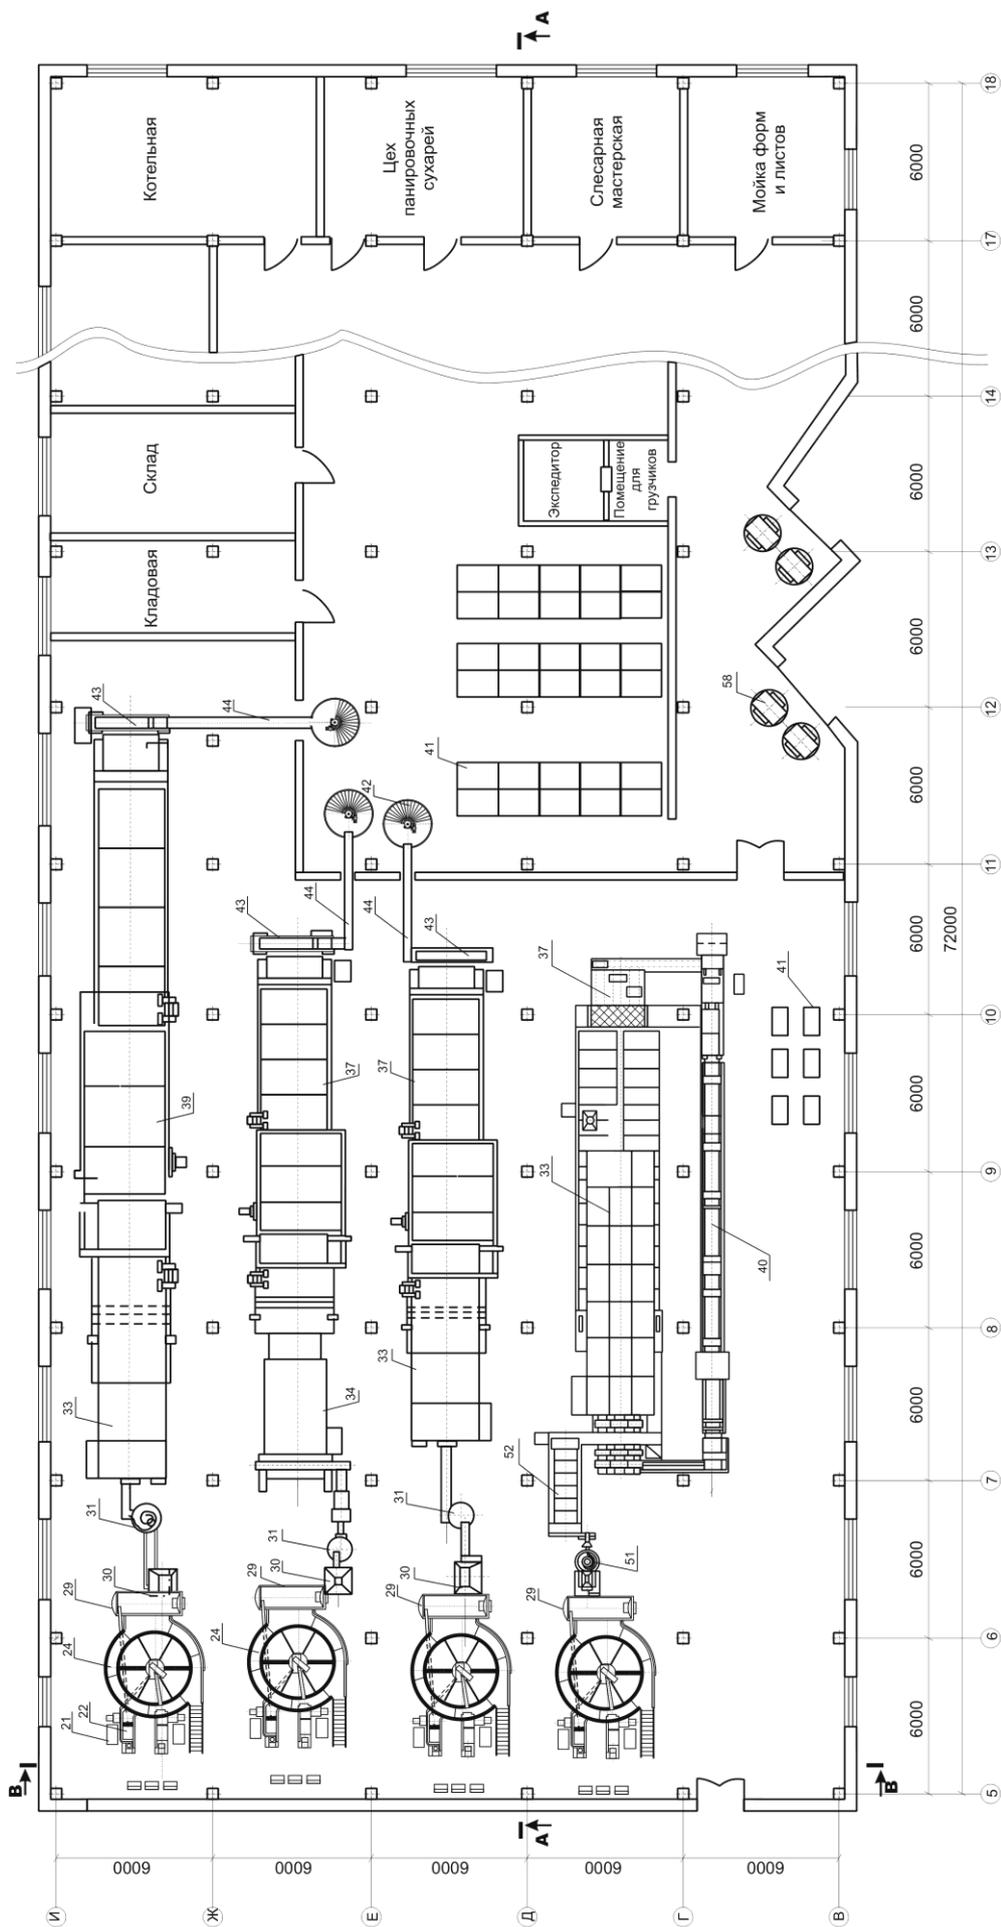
План первого этажа с компоновкой оборудования [2]
